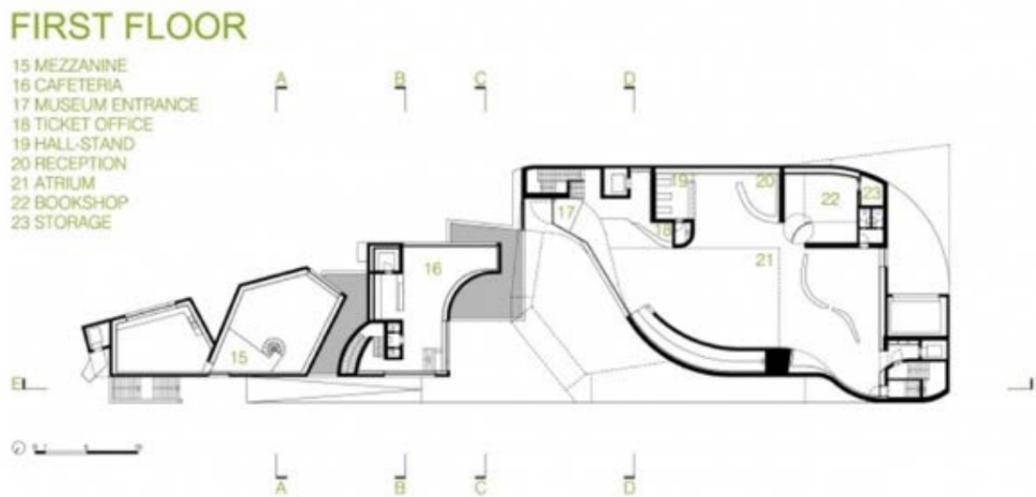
Fundação Iberê Camargo, 2003, Alvaro Siza. Planta do térreo. Fonte: Site Fundação Iberê Camargo, s/p.
